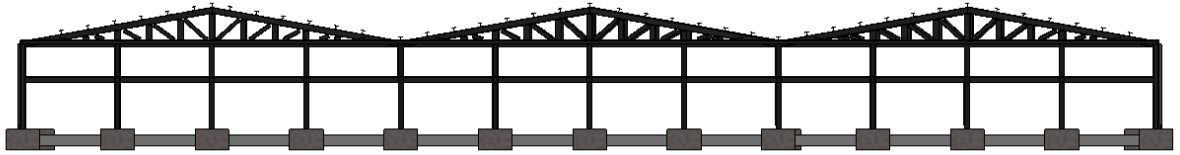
Vista frontal de la estructura de la nave Fuente: Elaboración propia
